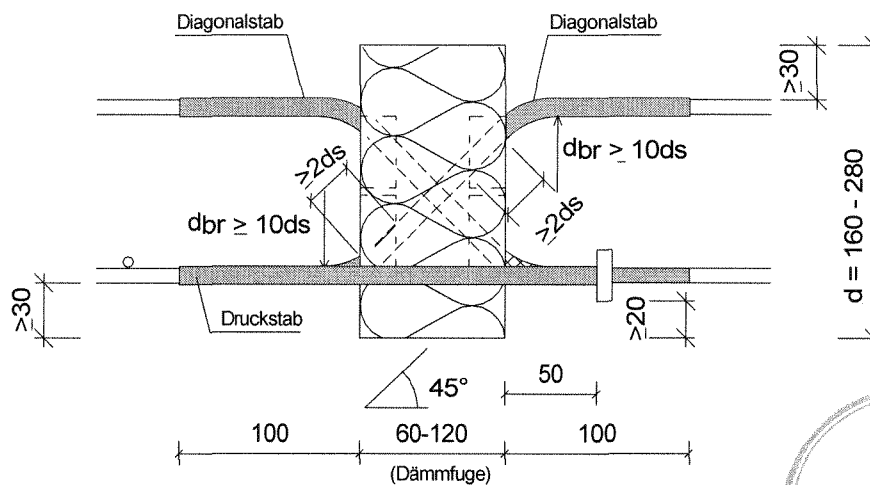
egcobox Plattenelement Typ PV-D +/-
